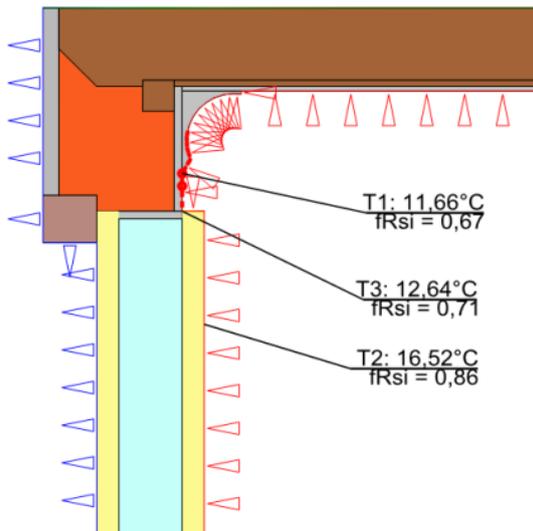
Wärmebrückenberechnung Deckeneinbindung, Planungsbüro J. Spieß
